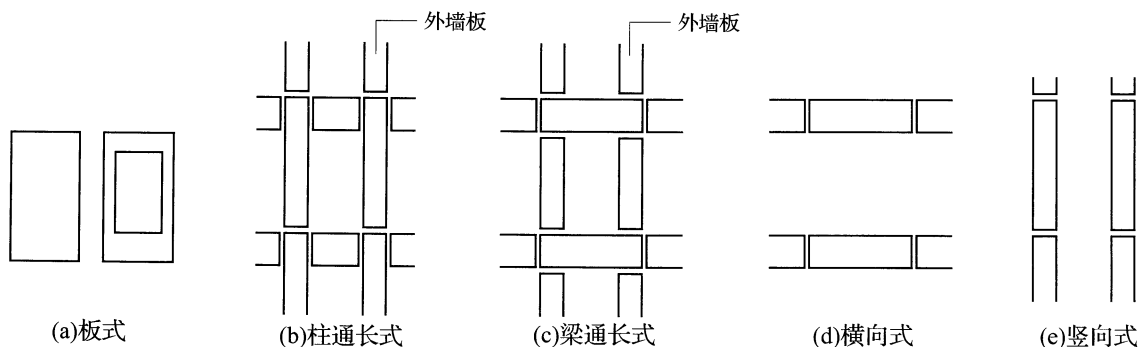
常用的预制混凝土外墙板立面分块方式
